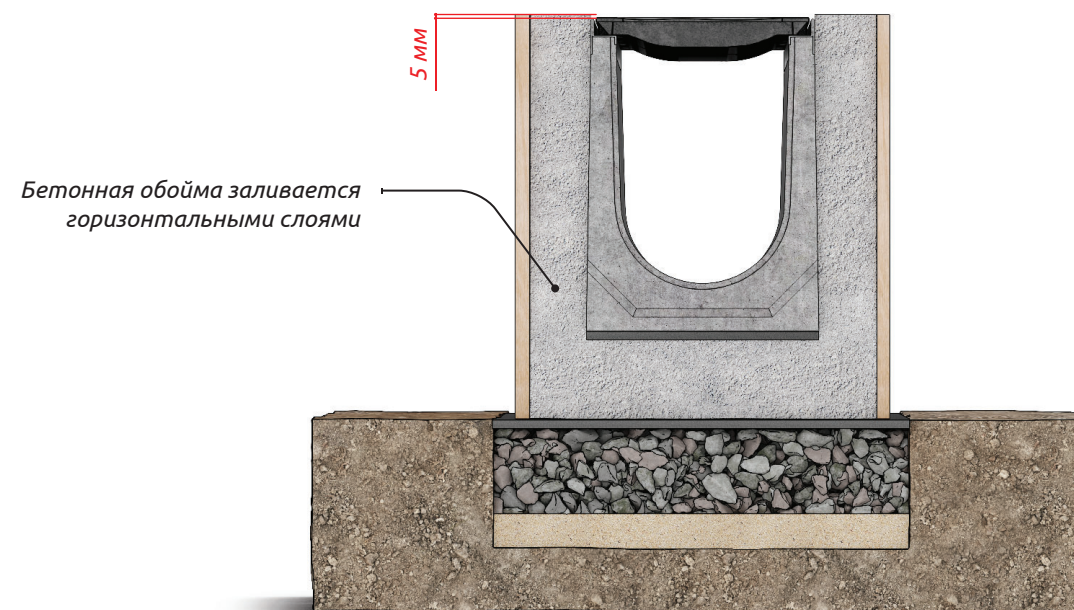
Бетонирование лотков для зон с повышенной нагрузкой.
